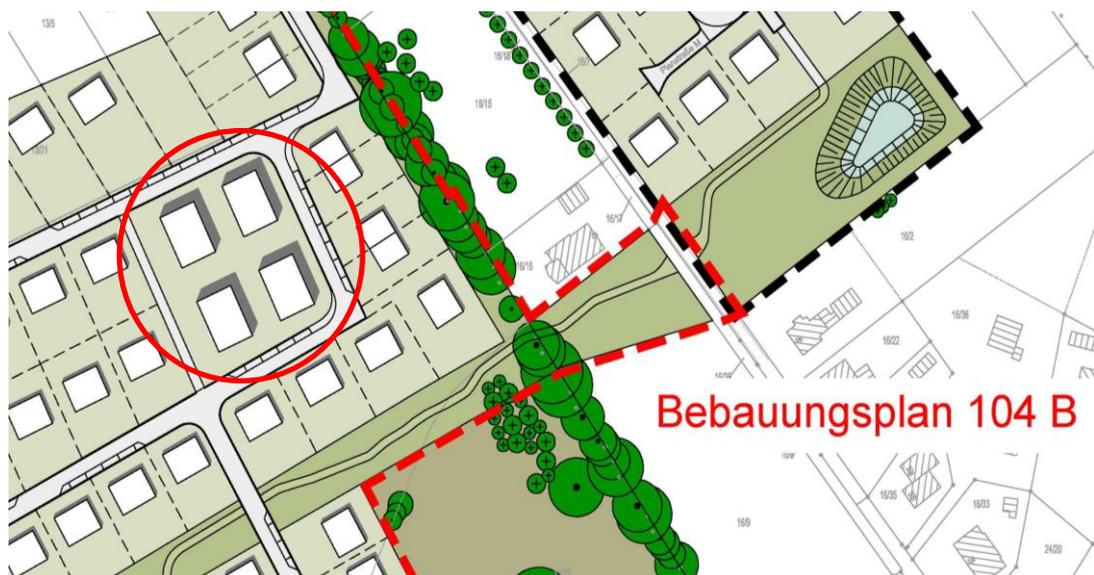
Entwurfsvariante für Geschosswohnungsbau
